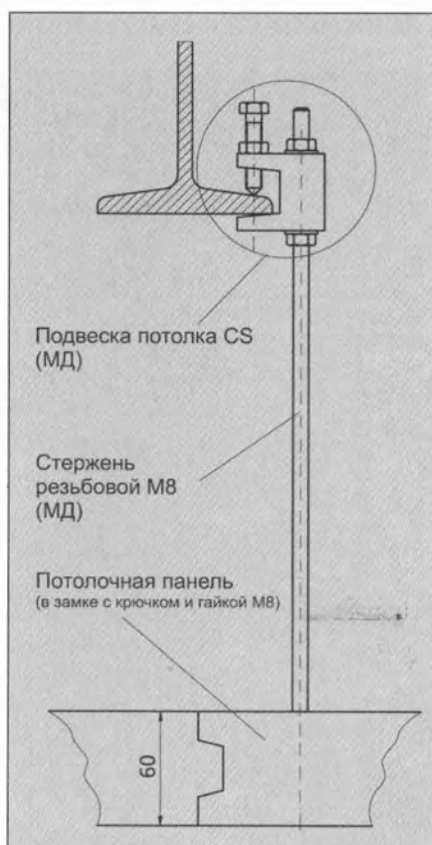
Крепление набора на вспомогательную конструкцию с помощью Подвески потолка CS
